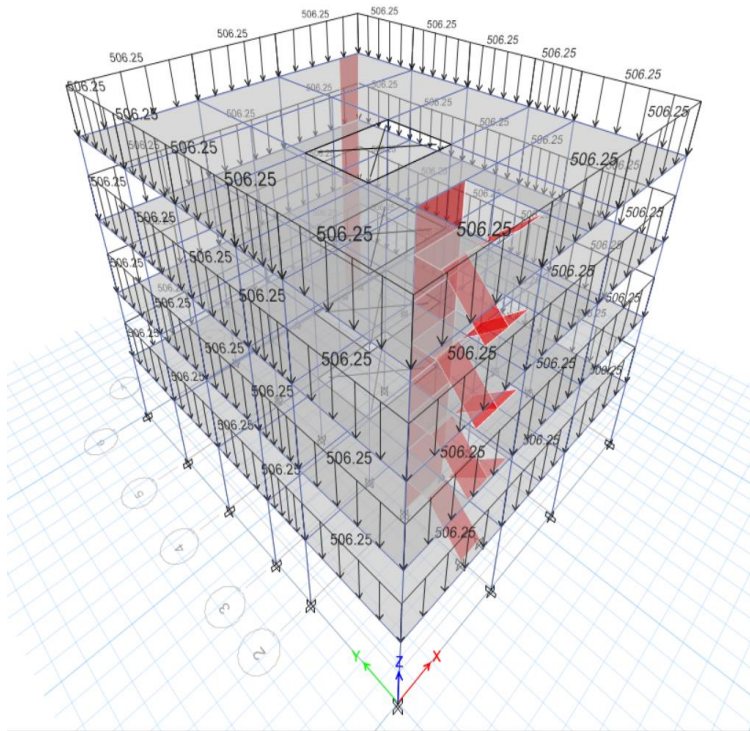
Vista 3D de aplicación de cargas en viga (Etabs)
